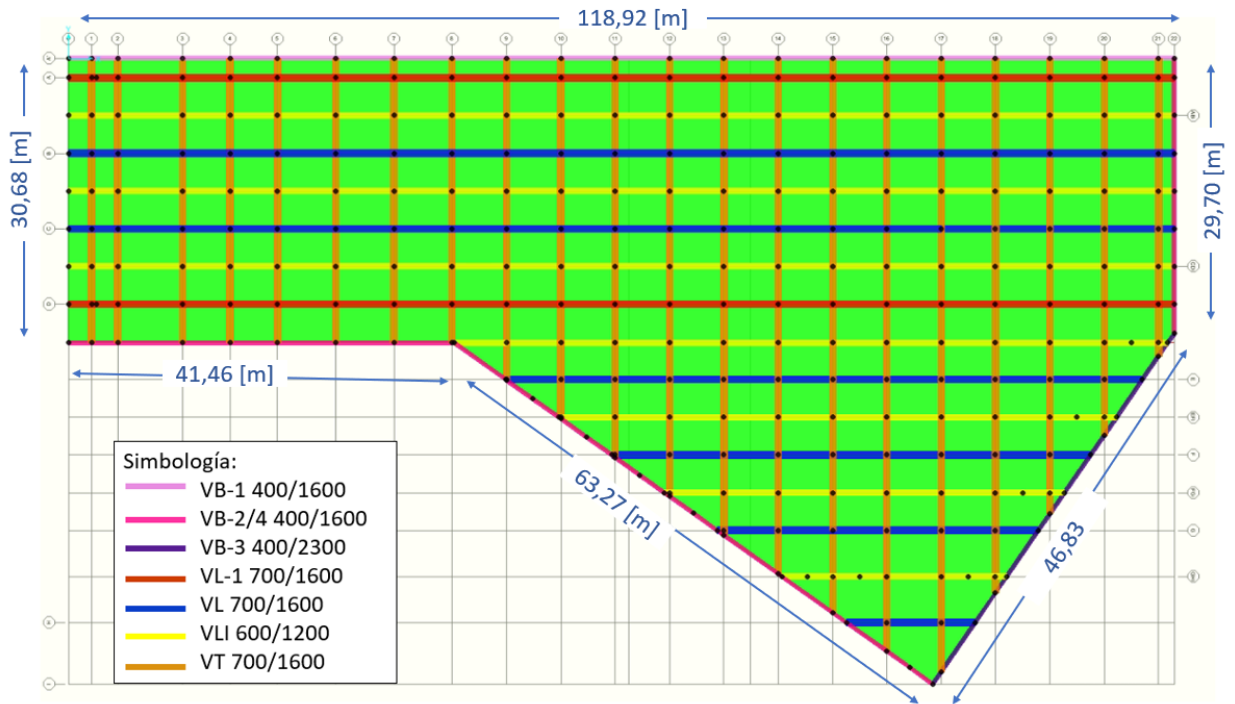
Vista en planta X-Y de la modelación del muelle.
